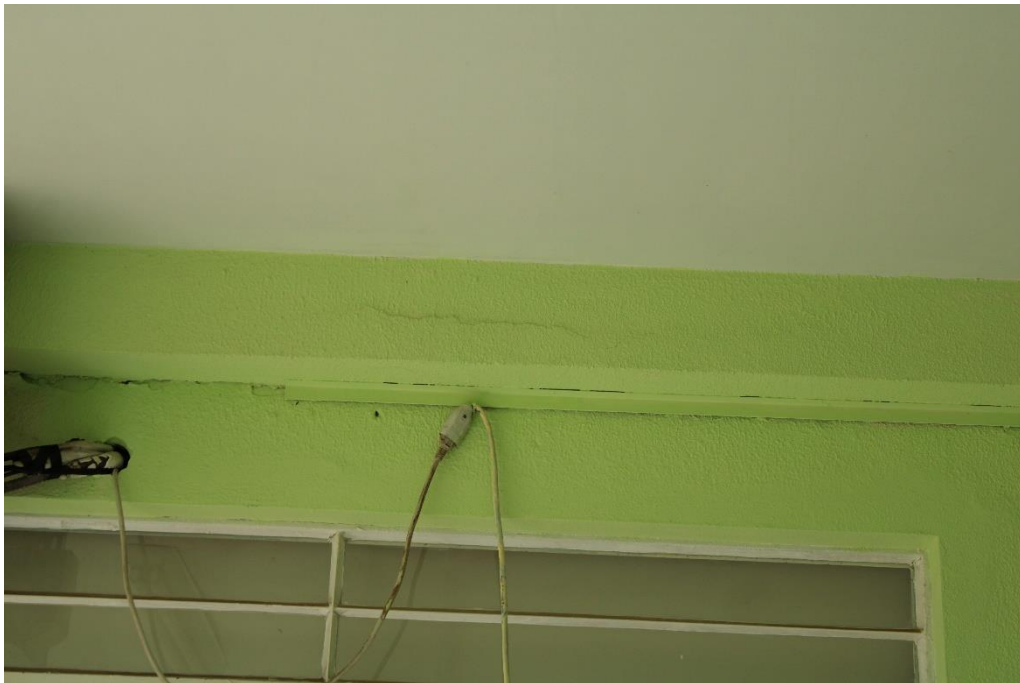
Em detalhe a foto prévia, destacando fissura horizontal.
